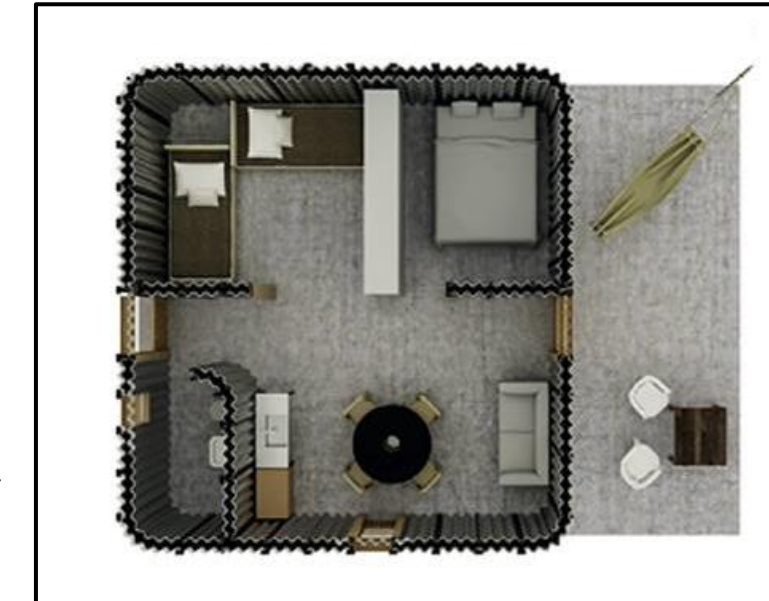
y 17. Plantas arquitectónicas y render de la propuesta "Tlacolula 3H"
